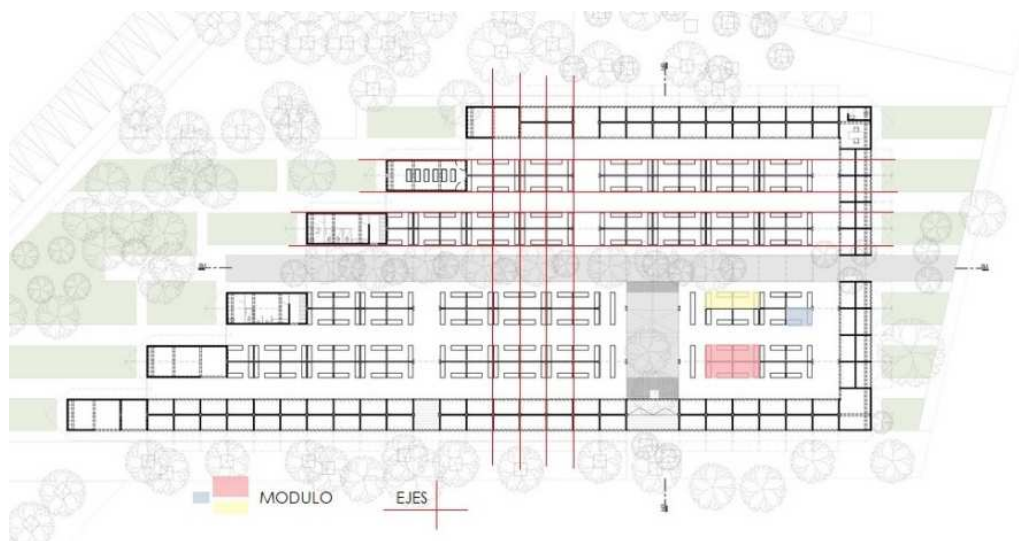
Planta Mercado Tapachula de Córdoba y Ordoñez
